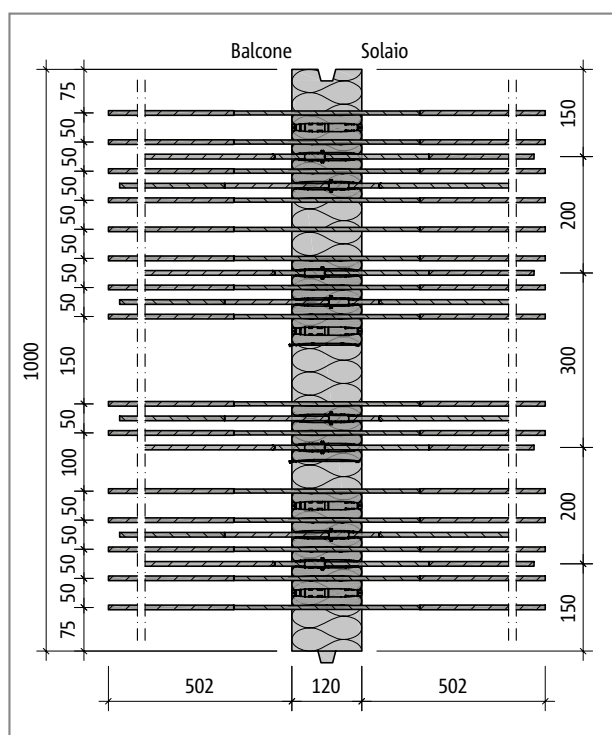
Schöck Isokorb® tipo KXT45-VV: pianta del prodotto
